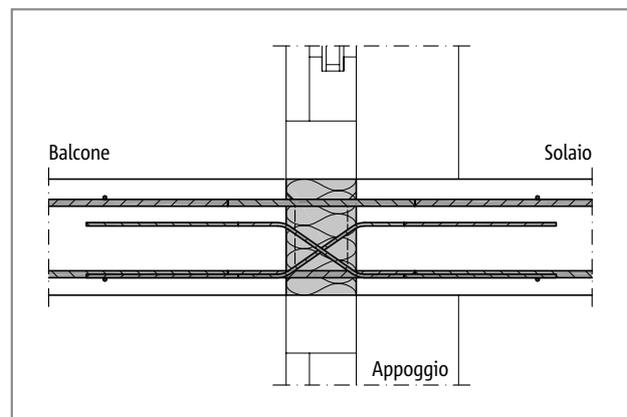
Schöck Isokorb® tipo DXT: sezione costruttiva; solaio piano
